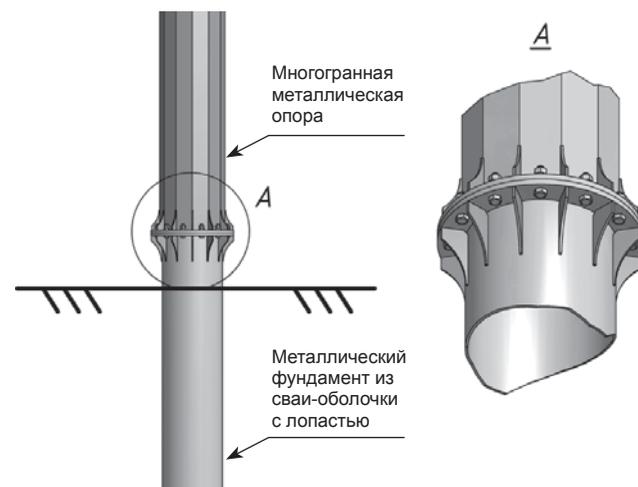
Схема фундамента из свай-оболочки трубчатого сечения, снабженного винтовыми лопастями
